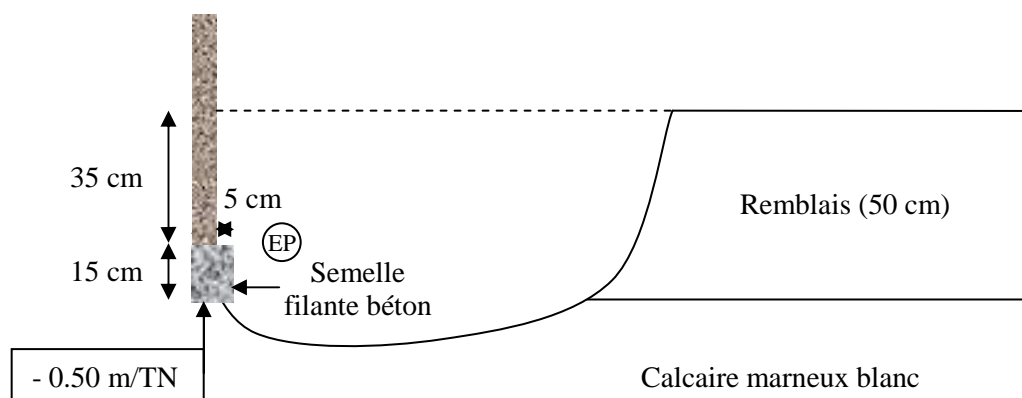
Schéma de la reconnaissance des fondations de l'existant (RF1) (échelle : 1/20).
